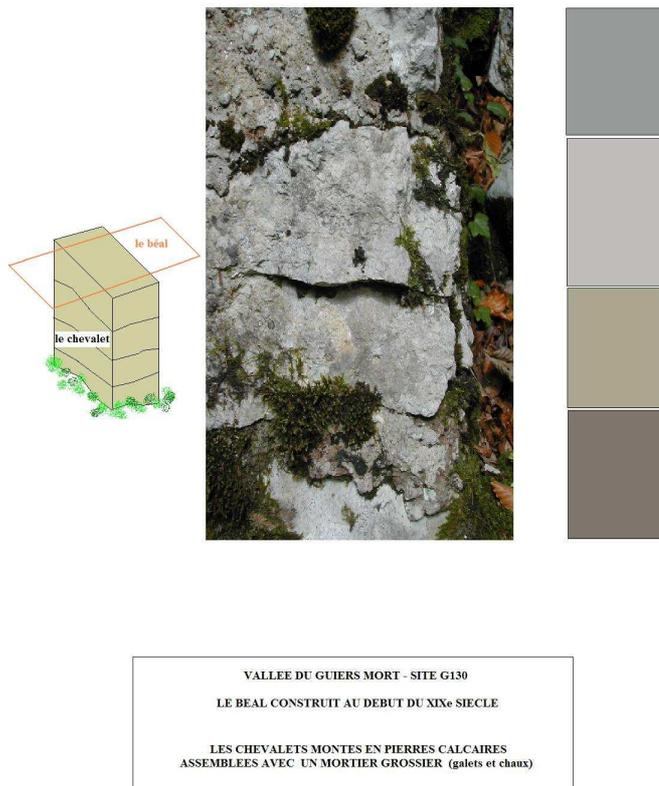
Fig : photographie (2009) d'un pilier monté en pierres calcaires maçonnées
